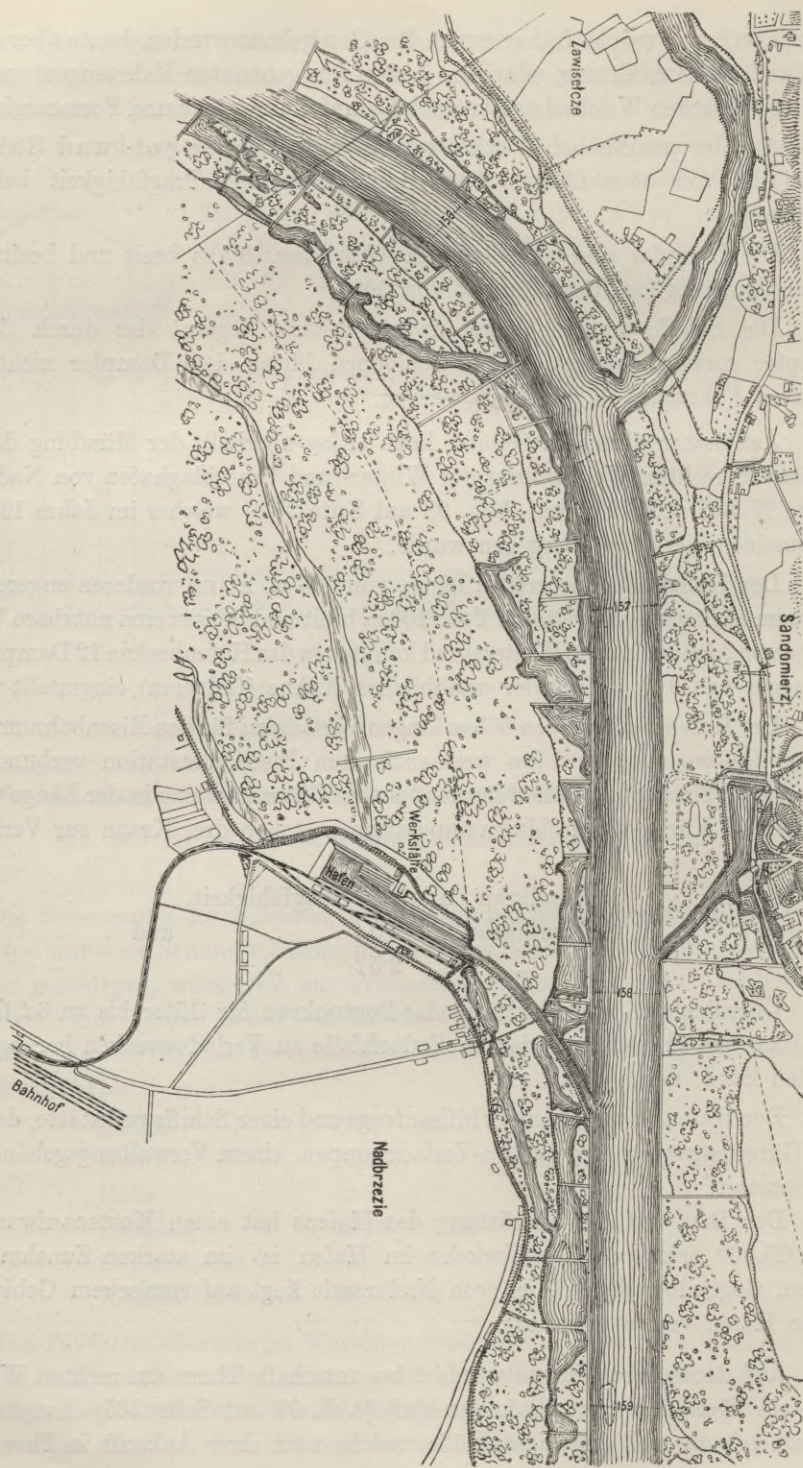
Lageplan des Hafens bei Nadbrzezie.
